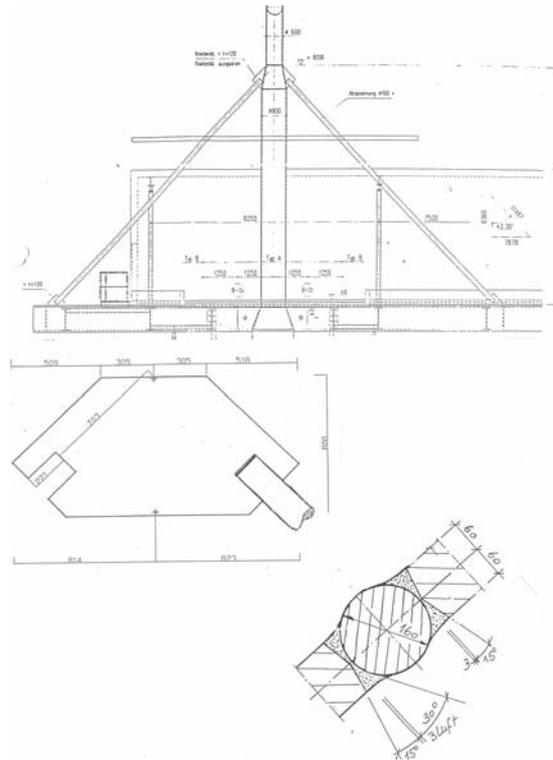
Stabanschluß mit geschweißter Steckverbindung (Beispiel 4)
